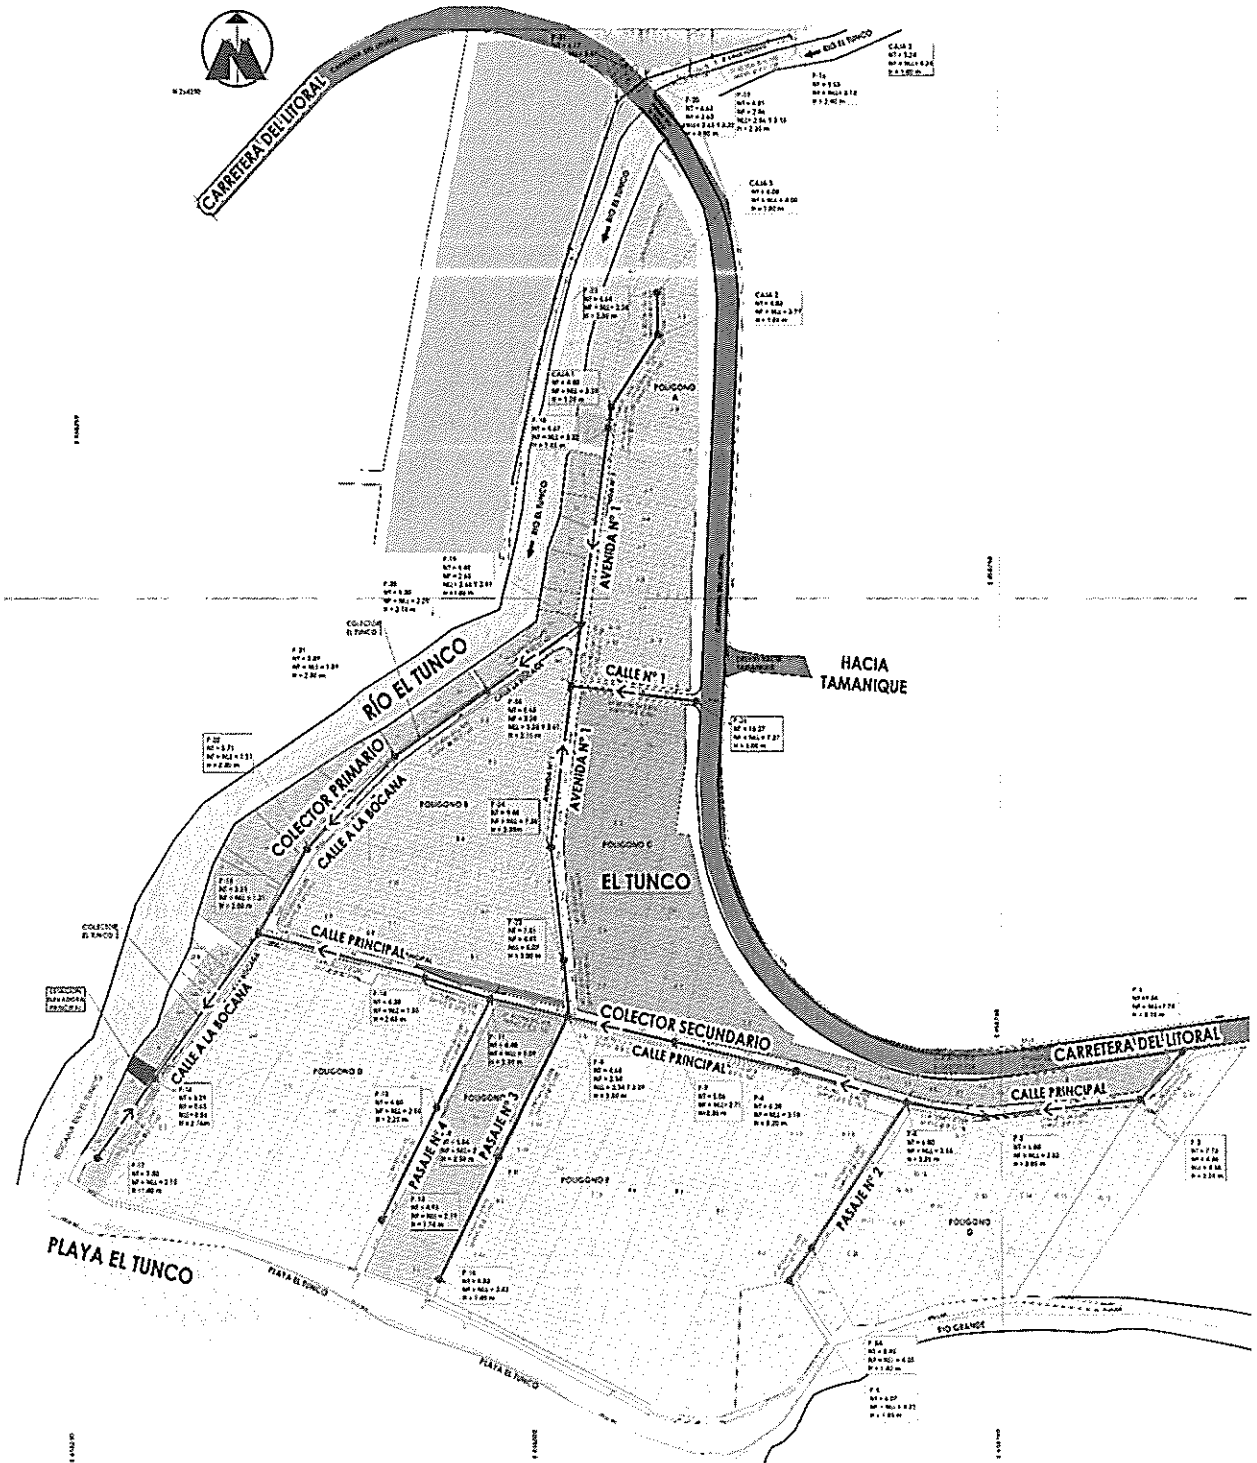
Esquema de alcantarillado sanitario playa El Tunco.
